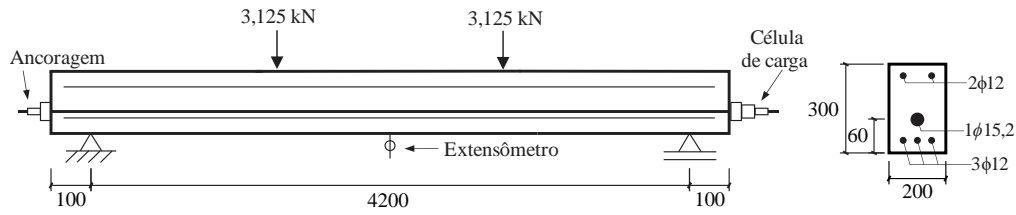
Detalhamento da viga PC5. Medidas indicadas em mm
